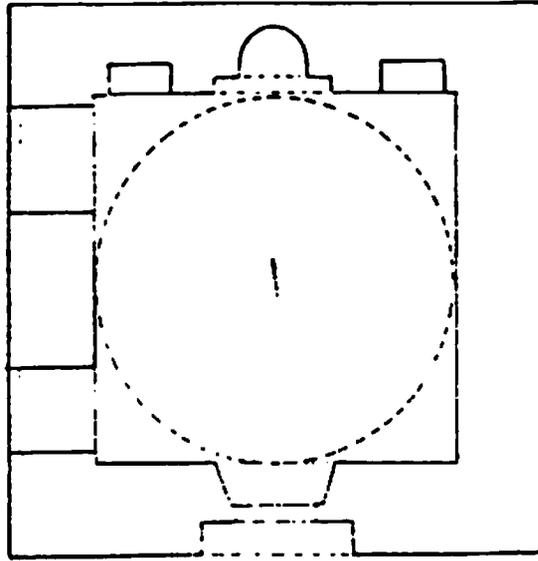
مسقط أفقى لقبة نصر الله عن هيئة الآثار
